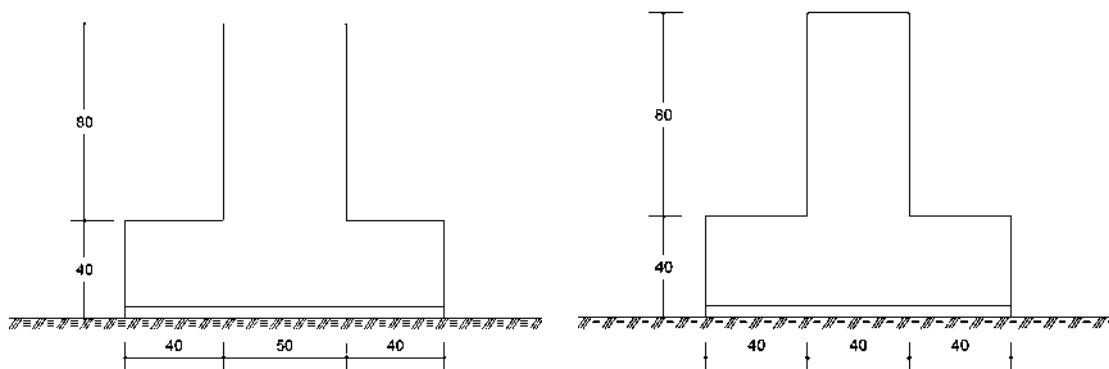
(b) Dimensiones propuestas de la zapata, vista en alzado, (cm)
